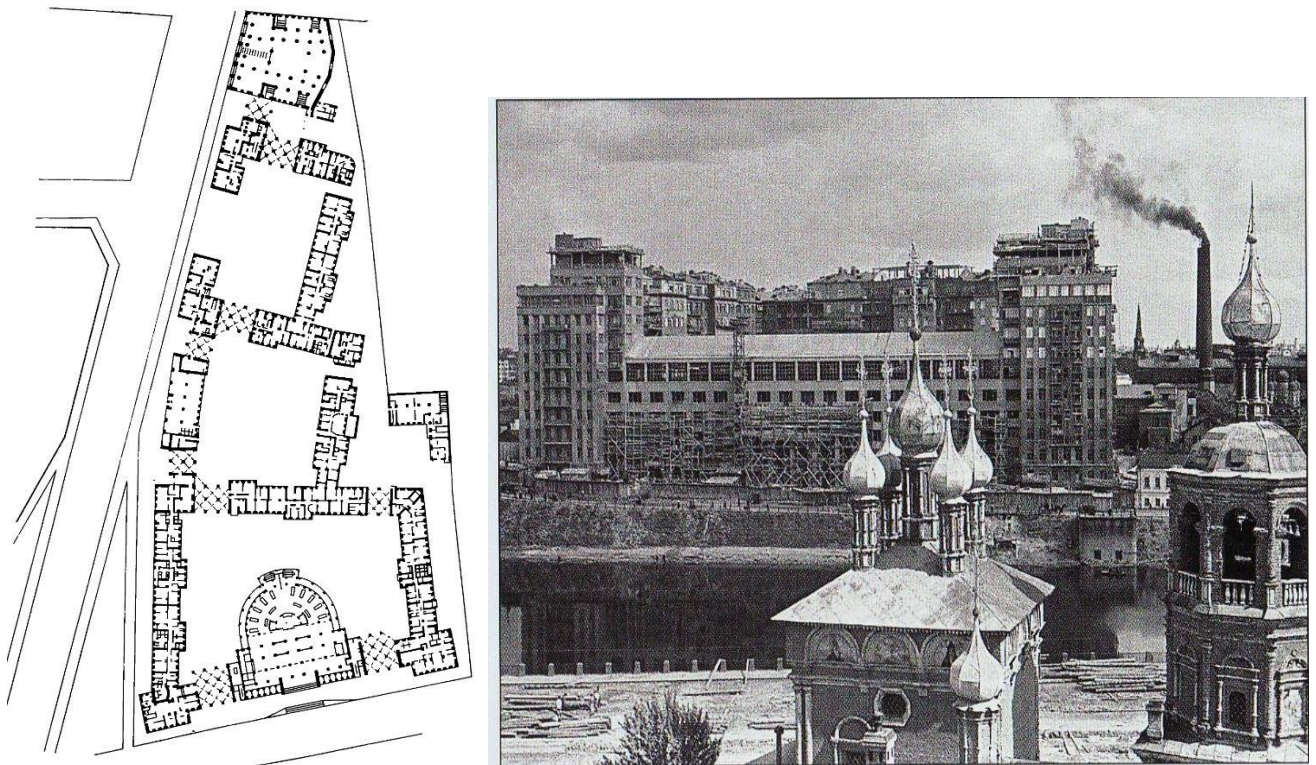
Дом на набережной Б. Иофан. Слева – план застройки комплекса, справа – архивное фото строительство Дома на набережной.
